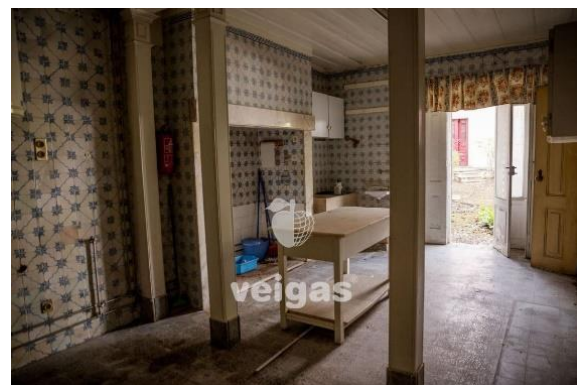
Fotografia da cozinha existente (vista 2)⁵
